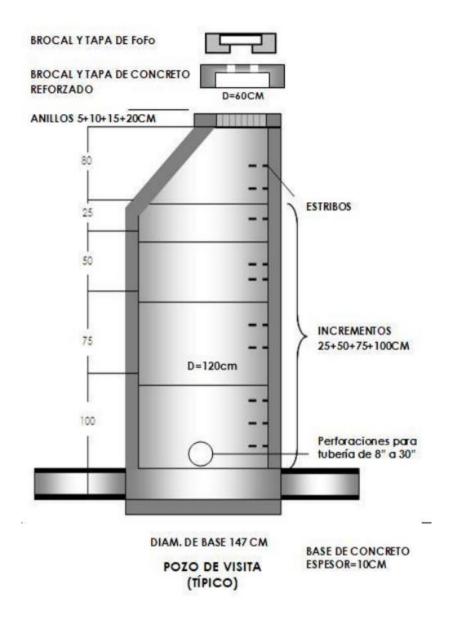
Pozo de visita de concreto prefabricado Fuente: (León Piedra Eduardo Alexis & Lindao Palma Gilson Eduardo, 2016)
